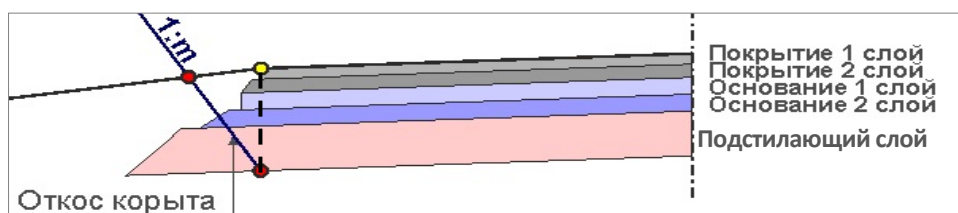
Ширина по низу корыта определена по кромке покрытия
